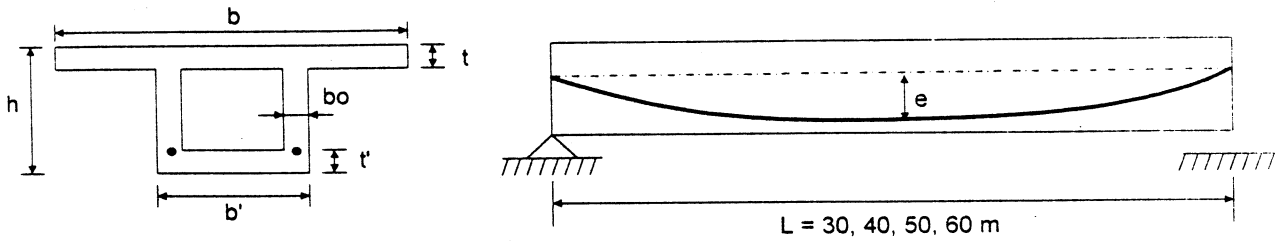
최적 설계 대상 PSC Box Girder 교량의 횡단면과 종단면
